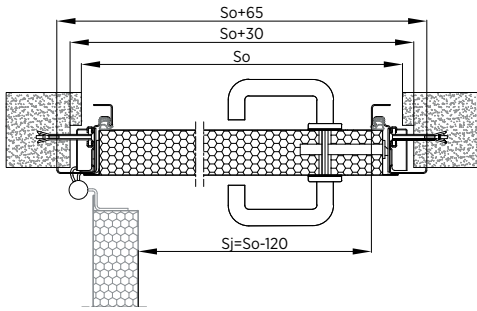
Pose au mur - bloc-porte à un vantail, bâti angulaire à rupture de pont thermique - coupe horizontale
